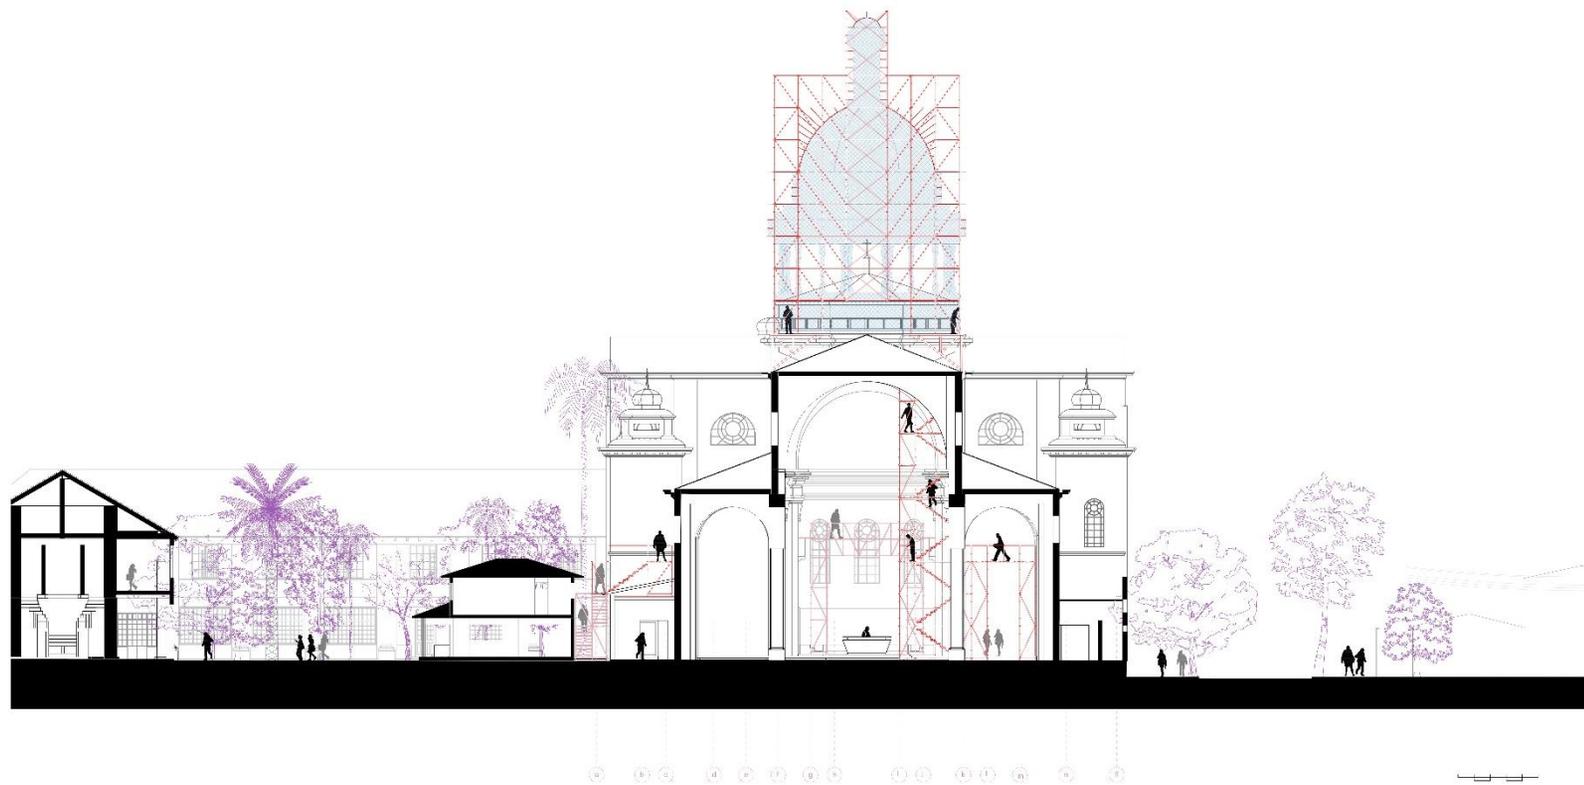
Planimetría proyecto sección transversal. Elaboración propia
